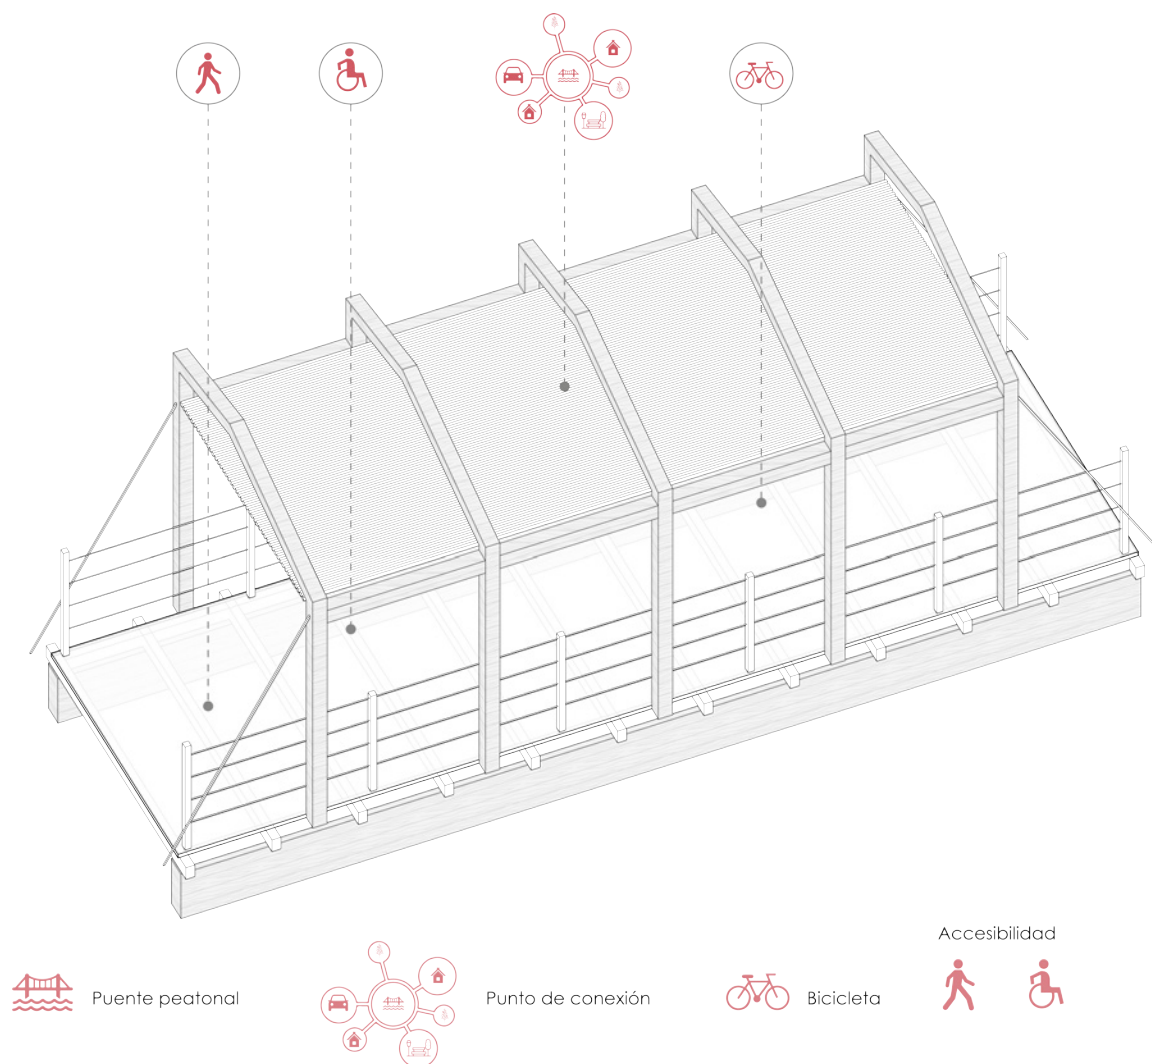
Axonometría – Puente peatonal. Fuente y Elaboración: Autora.
